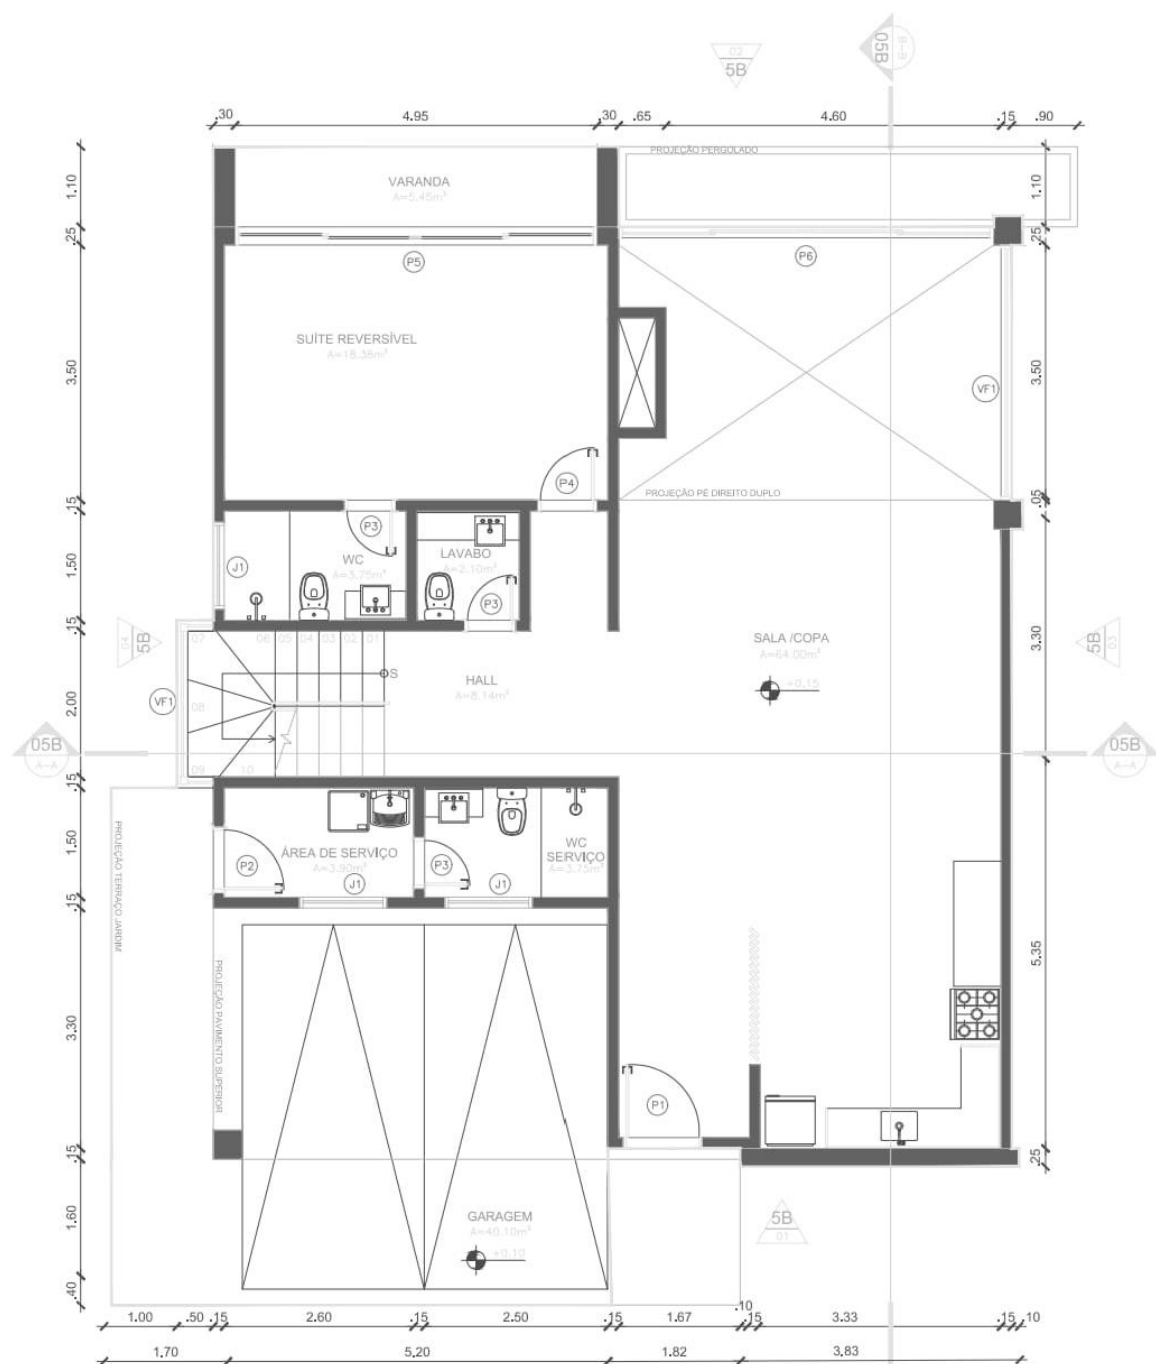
Planta baixa do pavimento superior – Residência Tipo B
